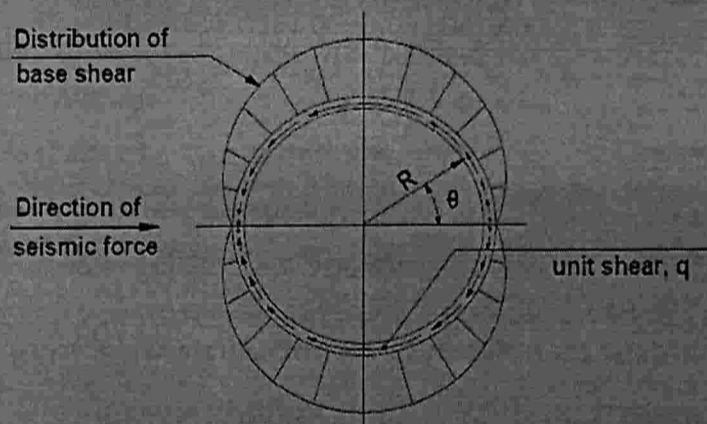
Distribución en planta de la fuerza de corte por sismo
